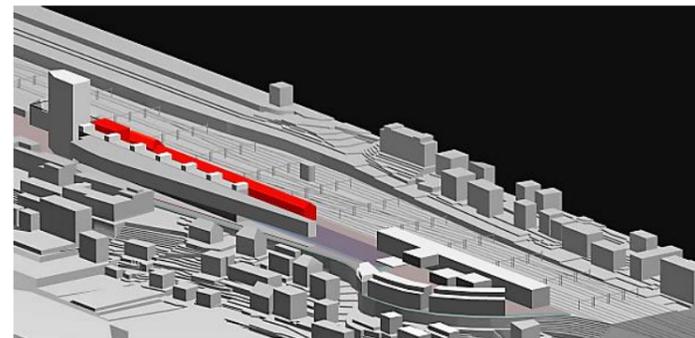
Plan de bâtiment TransEurope. Source : www.bauart.ch, traitement : Auteurs.
